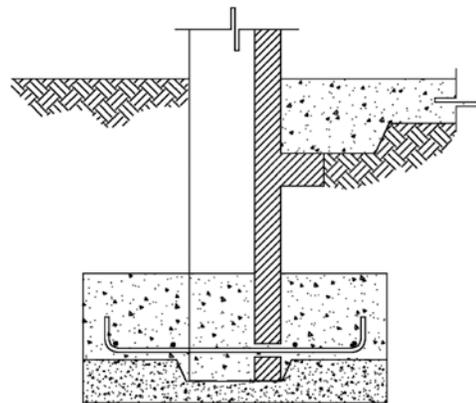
Detalle de fundación para naves industriales con paneles estándar
